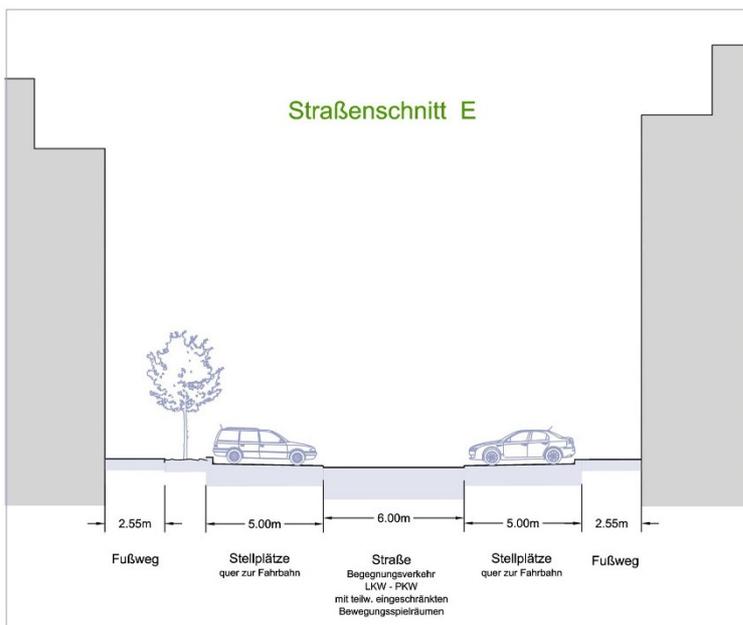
beispielhafter Schnitt der Erschließungsflächen im Plangebiet: Straßenschnitt E
